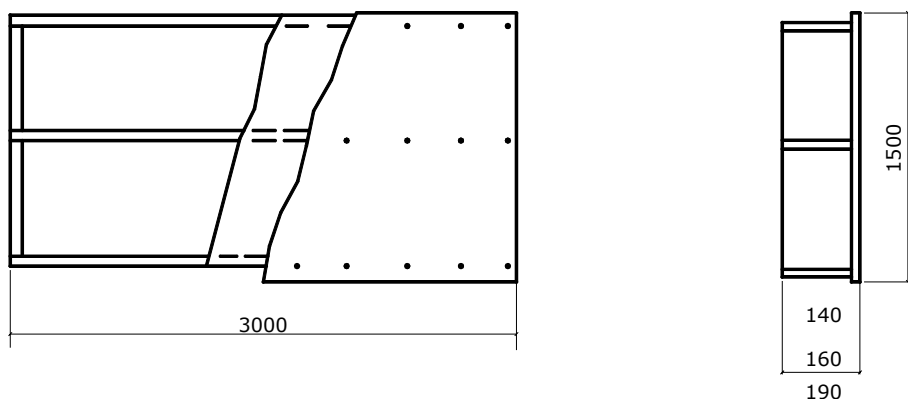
Плита перекриття на дерев'яному каркасі
